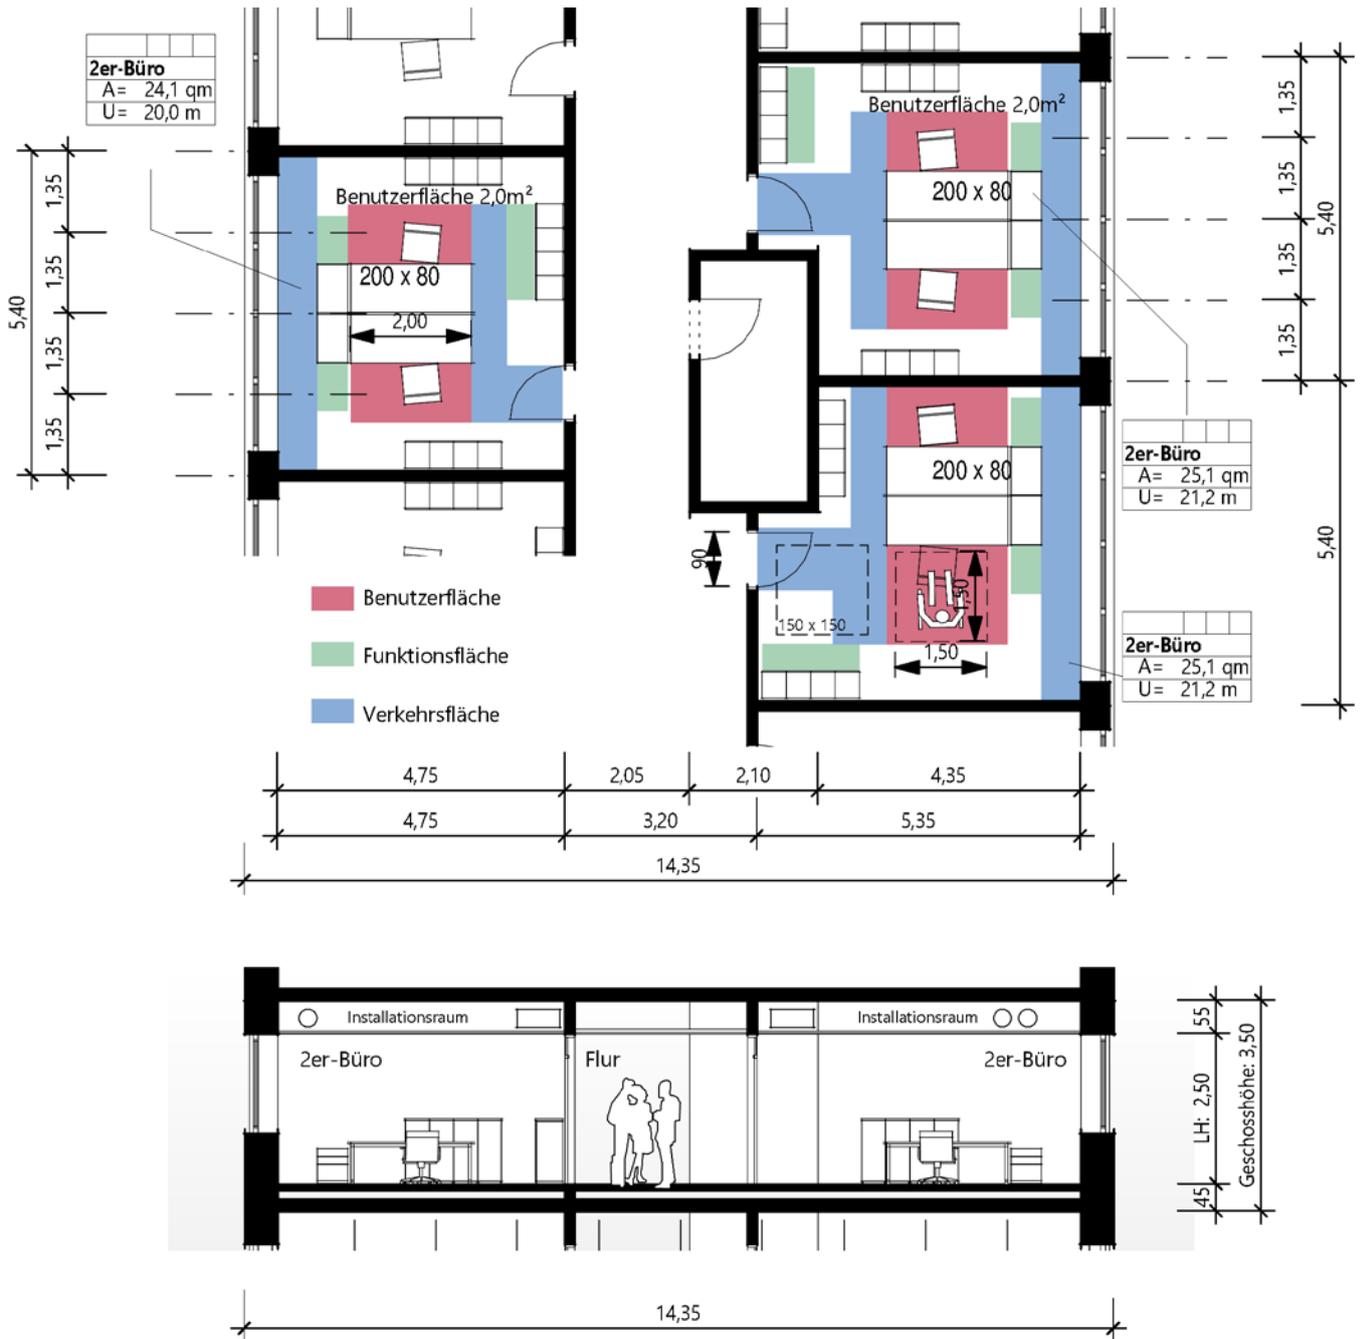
Grundriss und Schnitt - Maßstab 1:125
